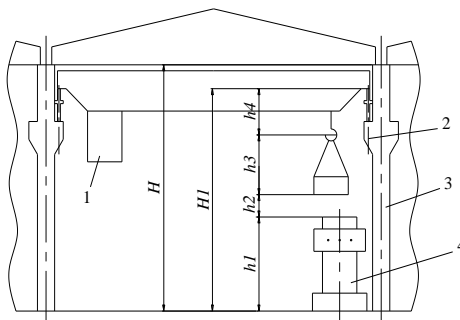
Поперечный разрез пролета: 1 – кабина крана; 2 – ось подкрановых путей; 3 – продольная разбивочная ось (колонна); 4 – технологическое оборудование.
